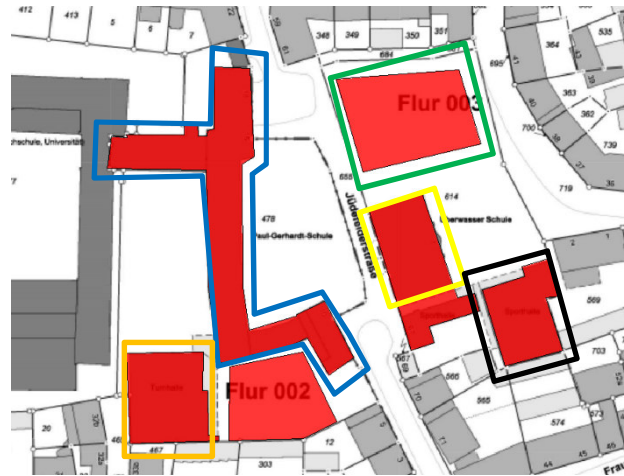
Gesamtschule Münster Mitte Lageplan
